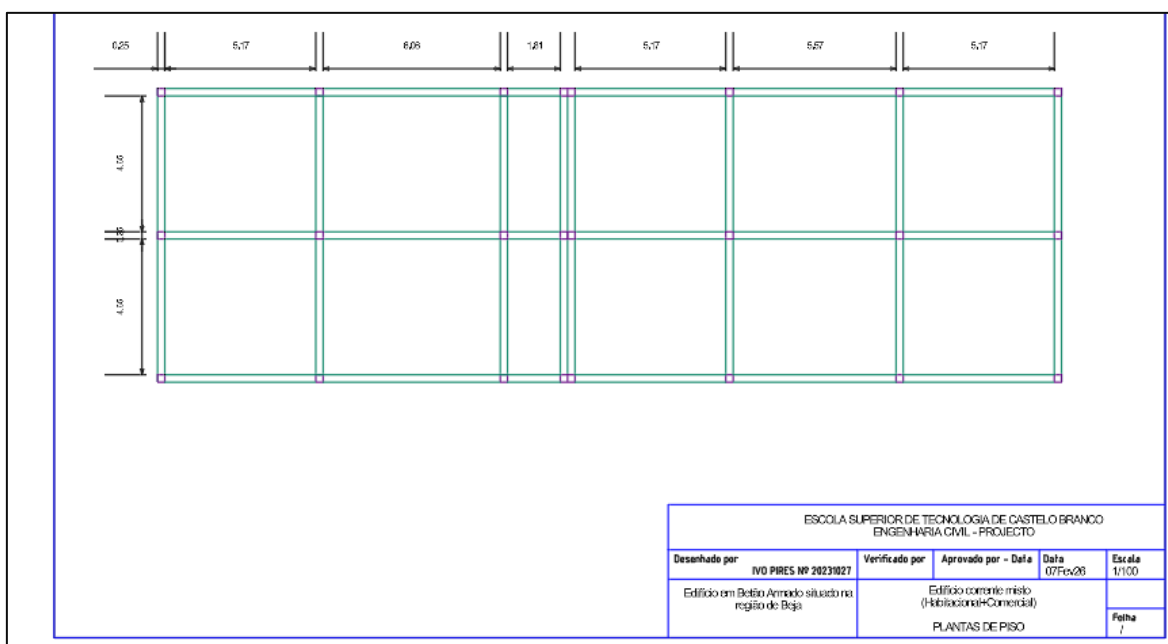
Planta dos pisos 1, 2, 3 e 4: Desenho do AutoCad segundo pré-dimensionamento, desenho proposto pelo autor deste trabalho
